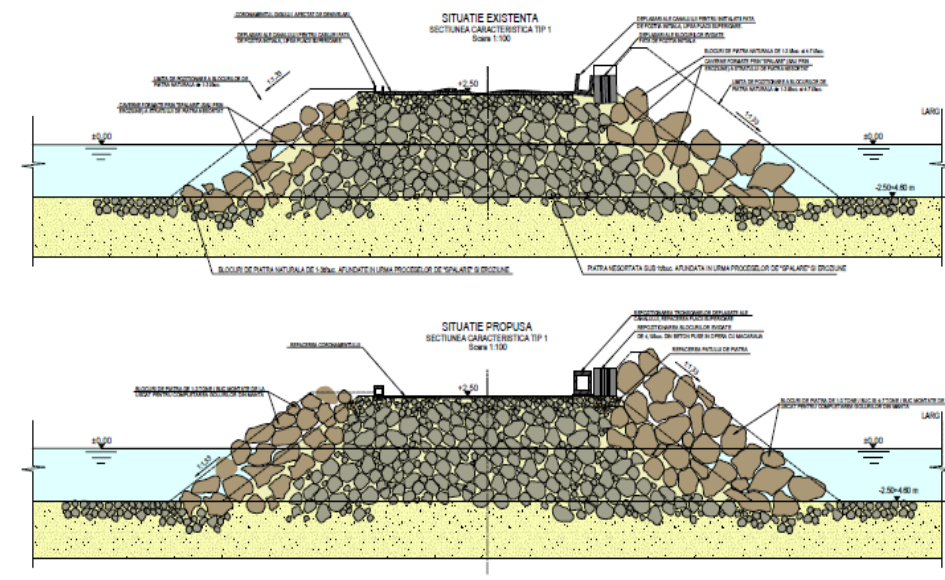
Sectiune caracteristica tip1 - situatie existenta si situatie propusa (sursa. planșa 05 Allplan)
